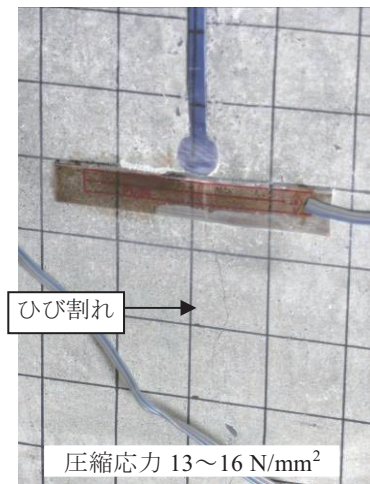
供試体3の荷重途中のひび割れ発生状況
